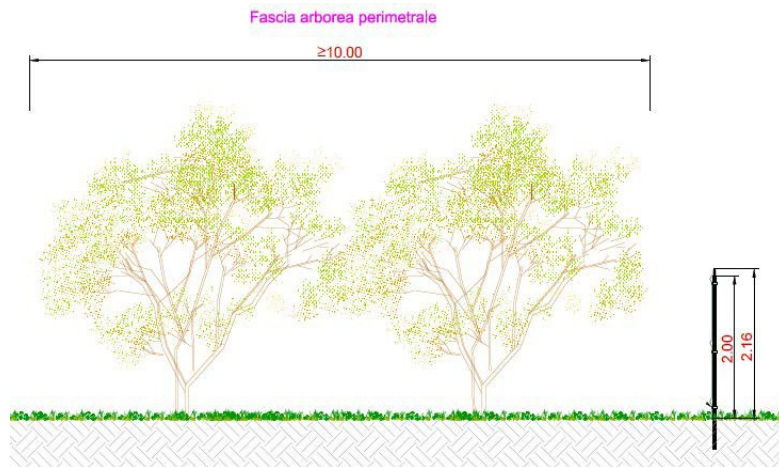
Schema delle opere di mitigazione visuale previste per tutti i confini dell'area di impianto.
